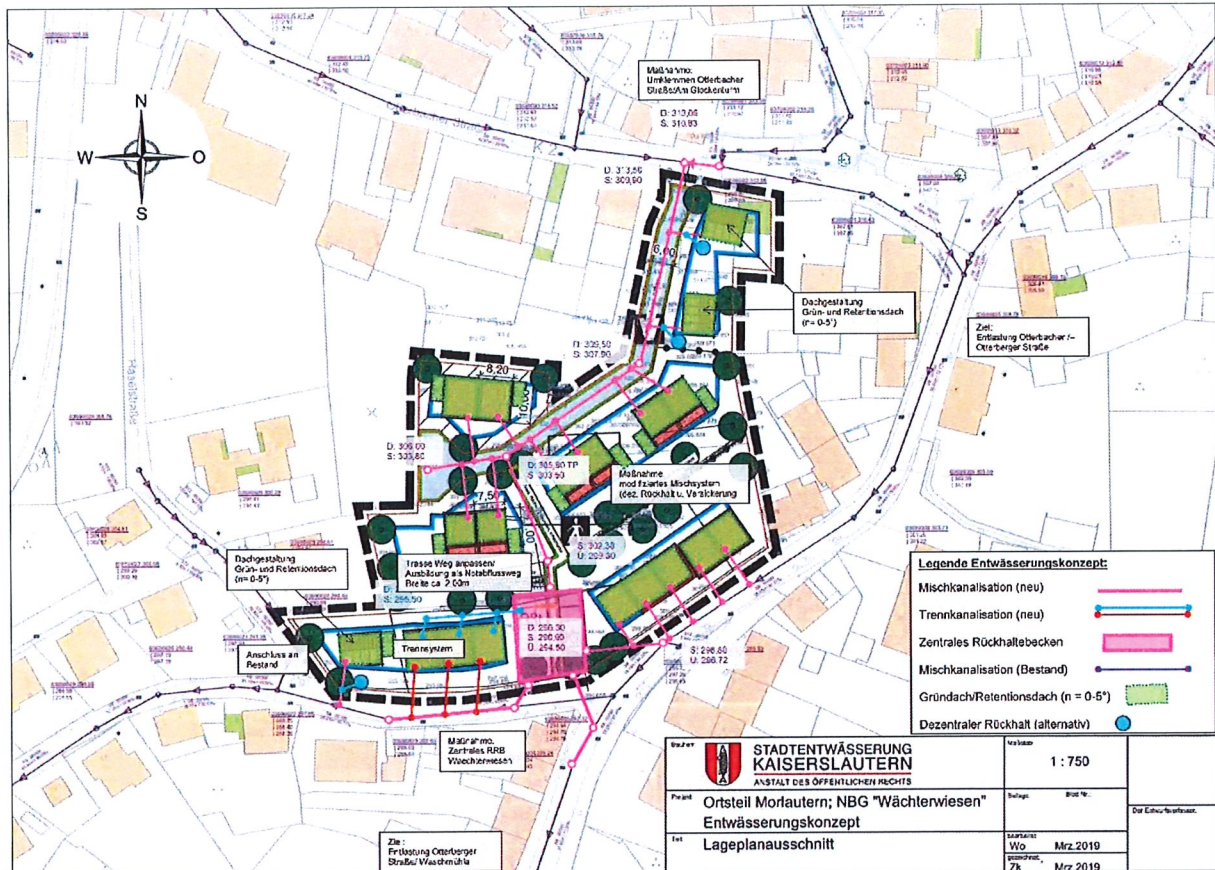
Planausschnitt Entwässerungskonzept, STE AöR
